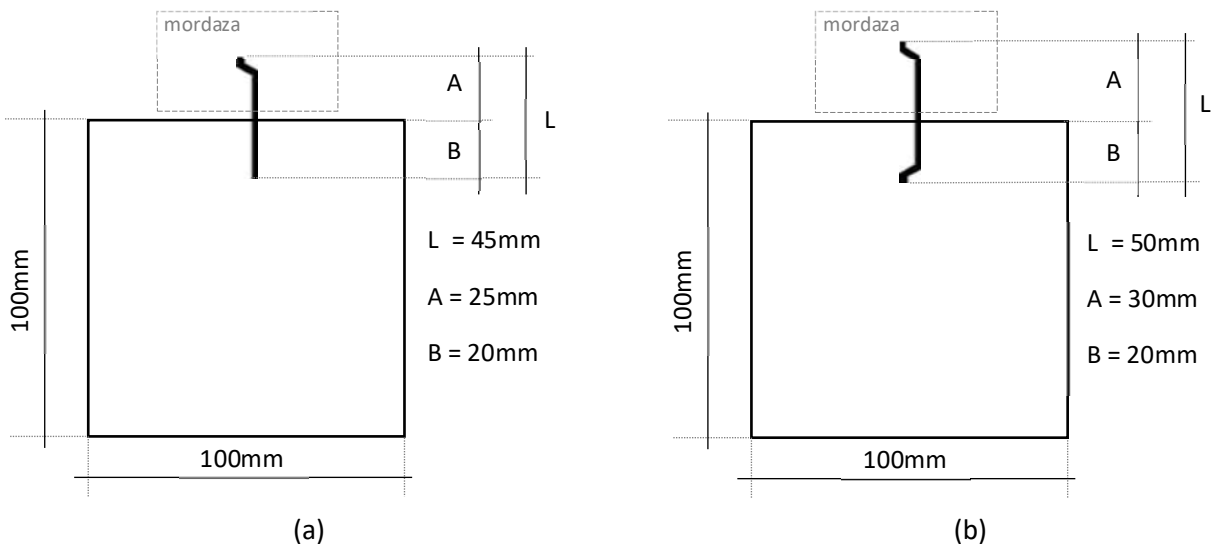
Configuración geométrica de las probetas utilizadas para el ensayo de pullout de una fibra aislada: (a) fibra con extremo recto, (b) fibra con extremo con gancho
